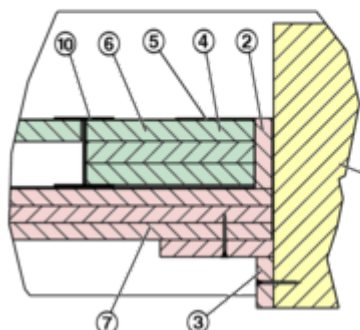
Słupki GypWall Shaft Replacement Studwork
